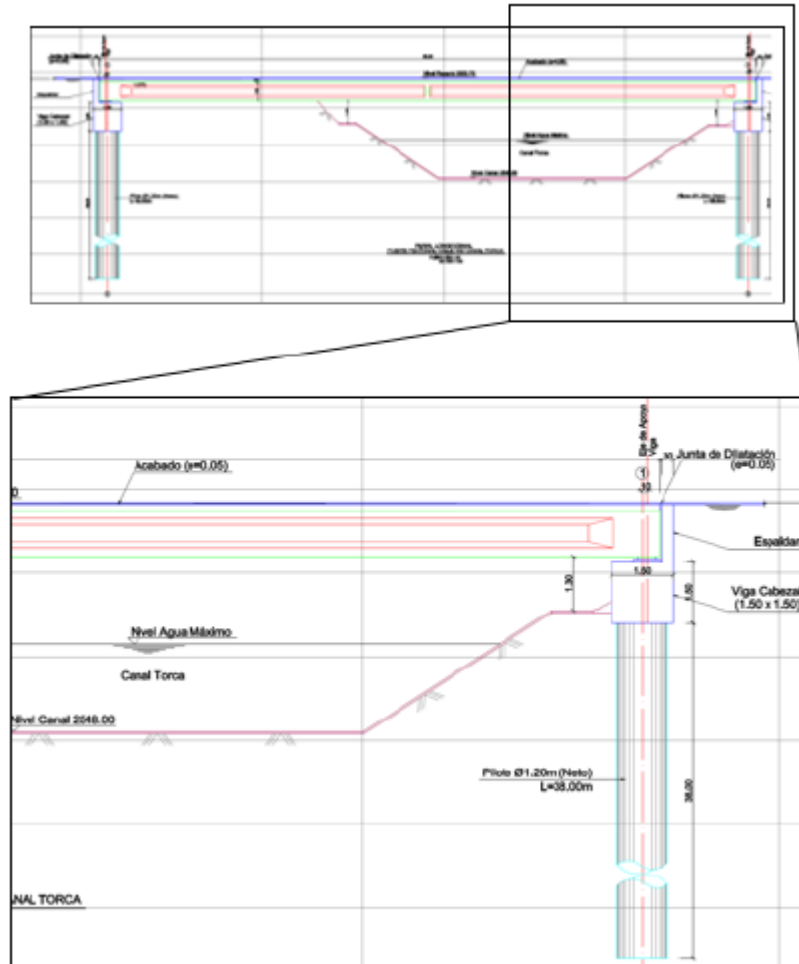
Perfil longitudinal puente peatonal costado norte.
